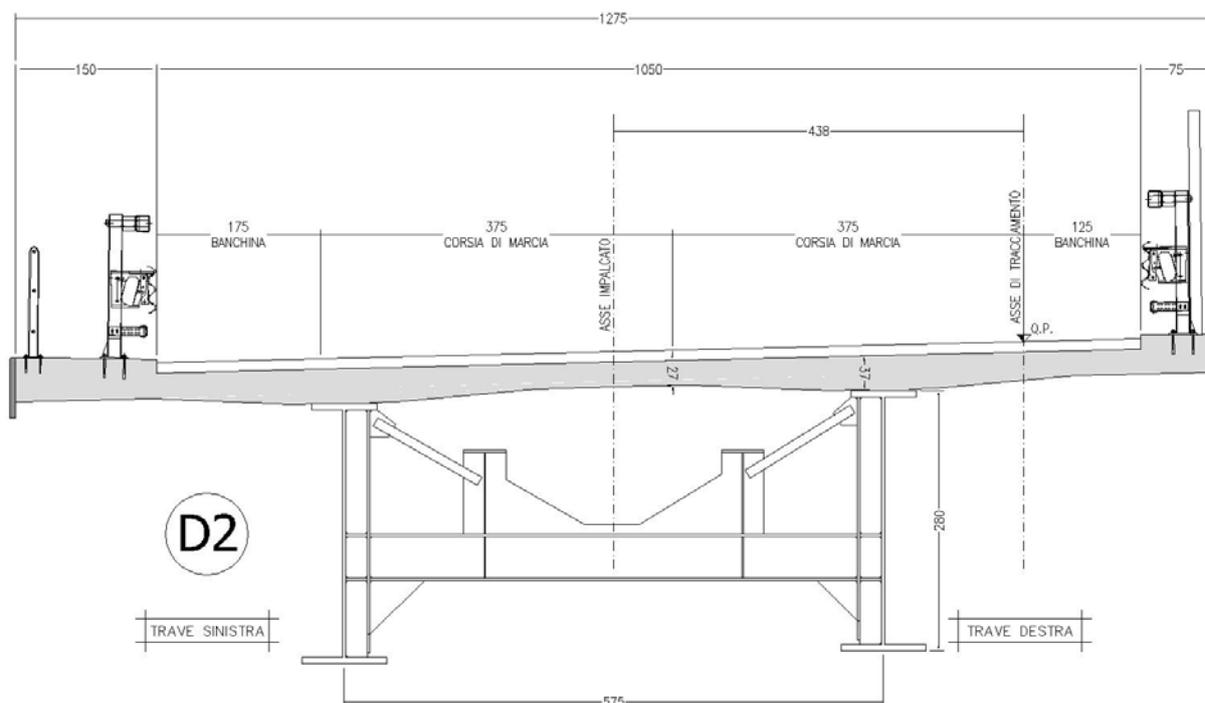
Sezione tipo impalcato progetto esecutivo (Carreggiata SX e DX).
